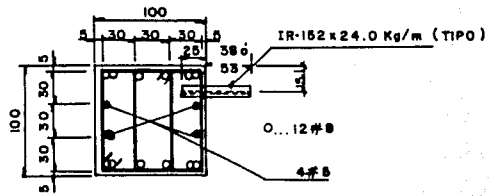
ARMADO DE TRABES DE CONCRETO.
